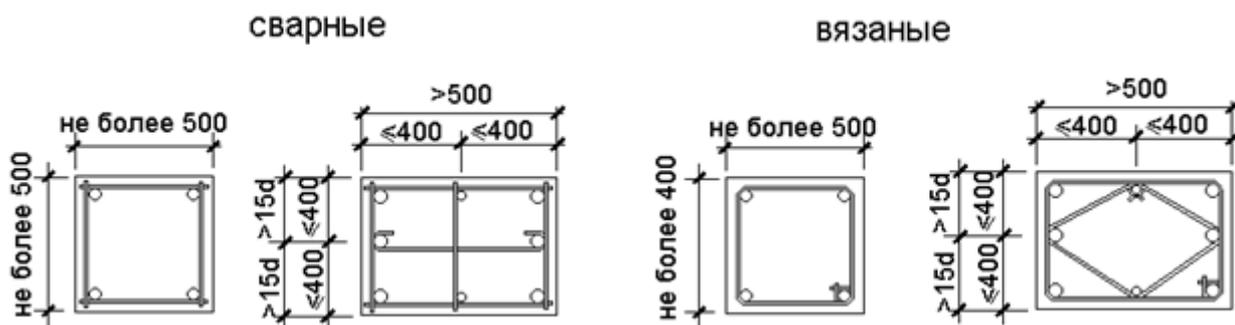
Конструктивные требования к минимальному количеству продольных стержней в поперечном сечении колонны
